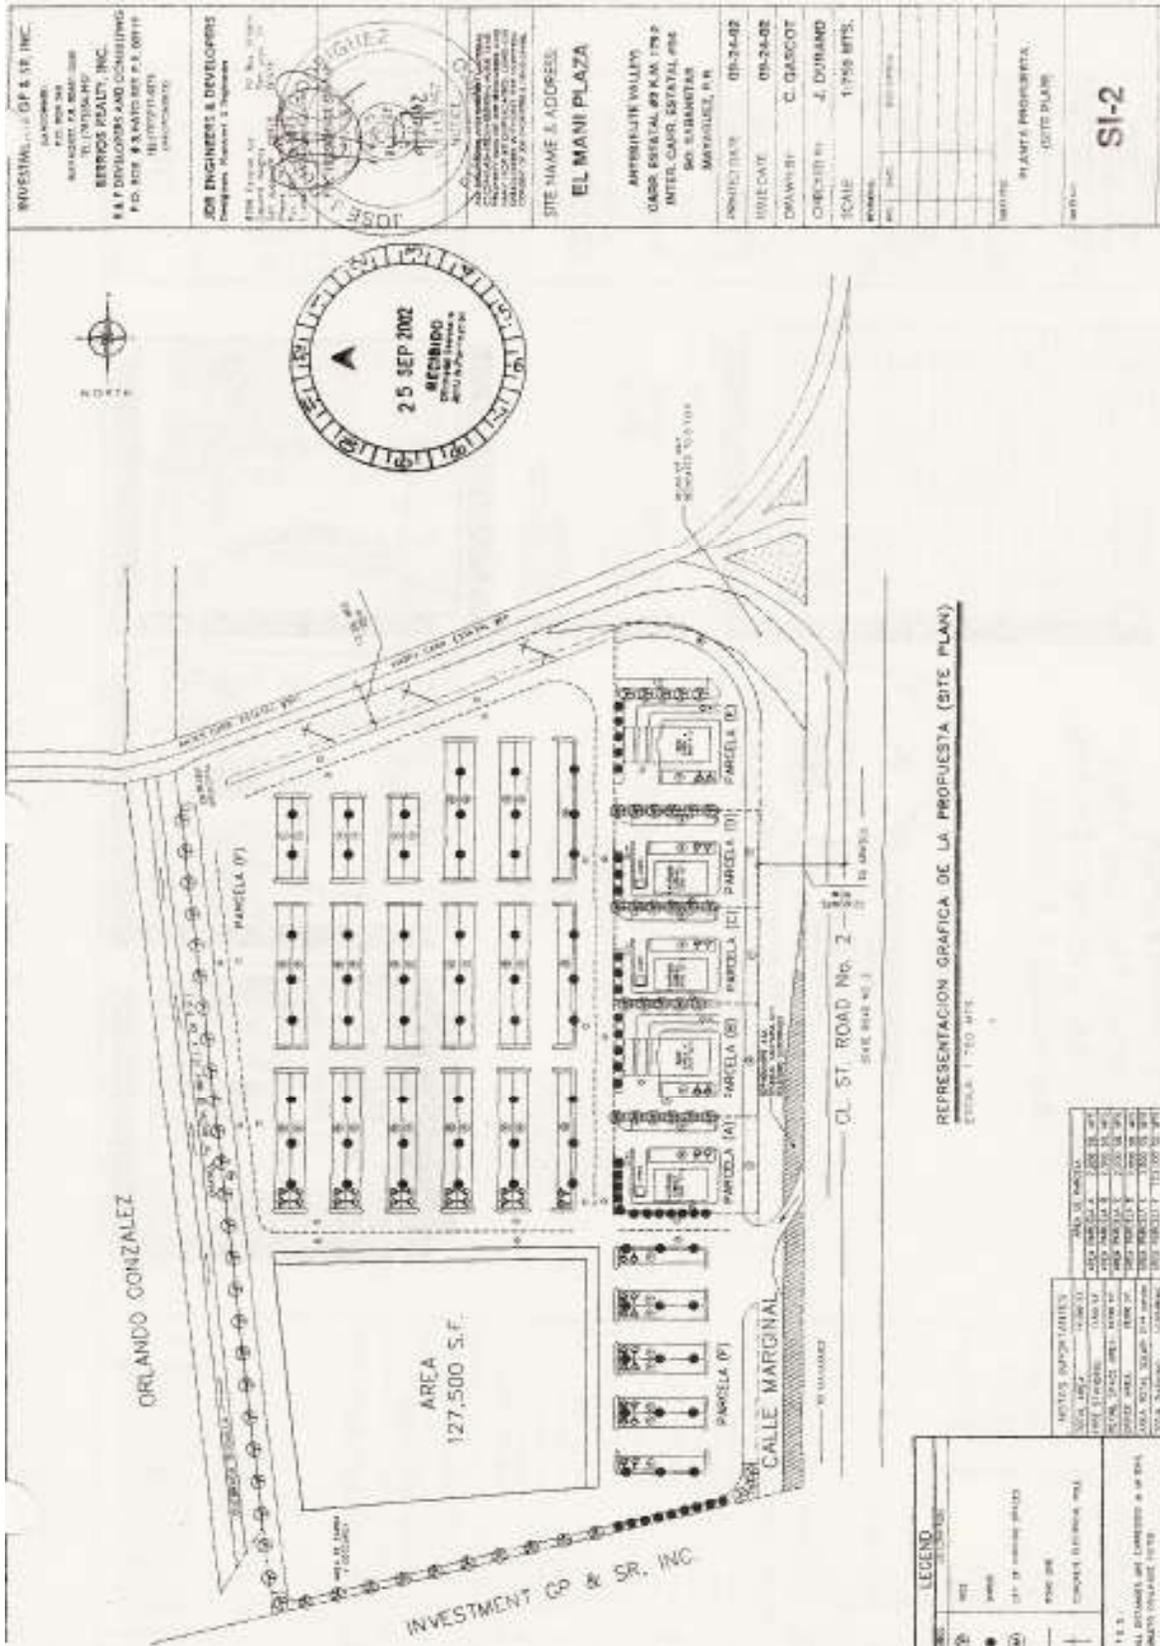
Planta del Predio con el Proyecto según Propuesto
